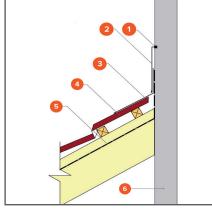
Примыкание ската кровли к стене перпендикулярно уклону
